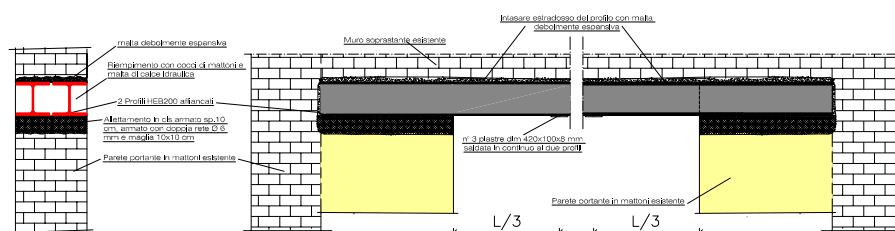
Dettaglio di realizzazione delle aperture in breccia nella muratura.
